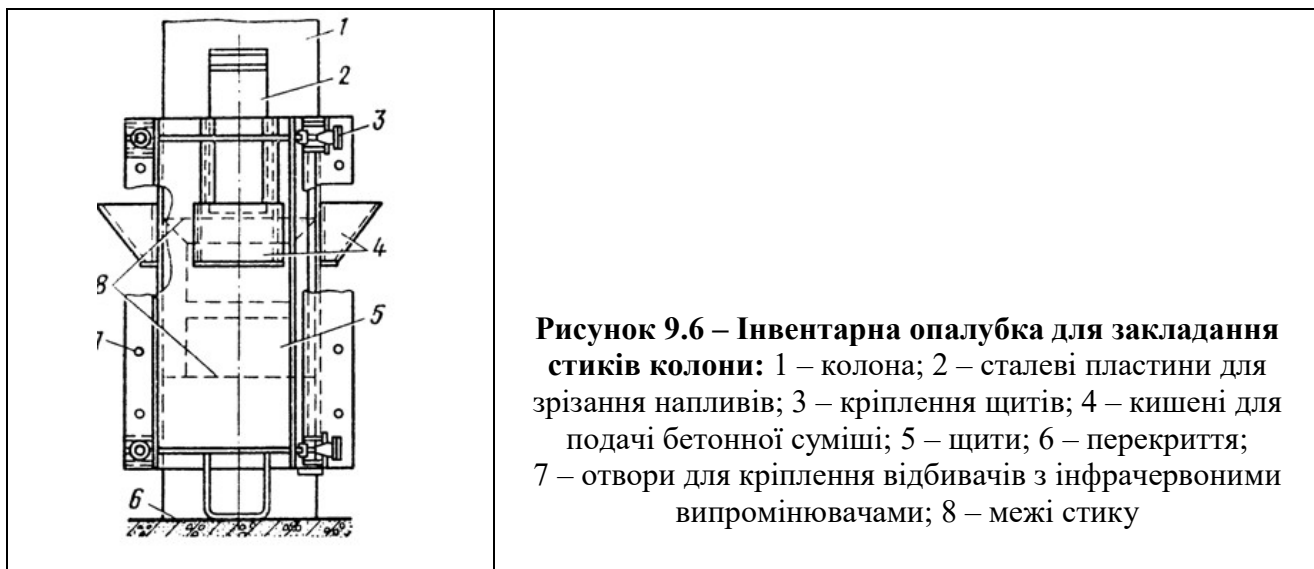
Інвентарна опалубка для закладання стиків колони: 1 – колона; 2 – сталеві пластини для зрізання напливів; 3 – кріплення щитів; 4 – кишені для подачі бетонної суміші; 5 – щити; 6 – перекриття; 7 – отвори для кріплення відбивачів з інфрачервоними випромінювачами; 8 – межі стику
